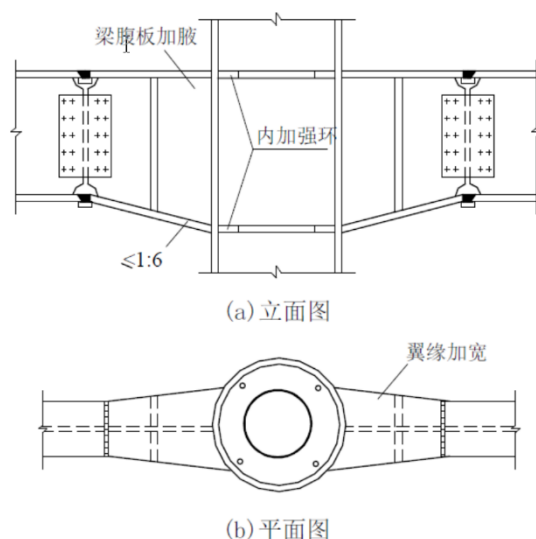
变截面的悬臂梁段与钢管混凝土柱刚性连接示意图
